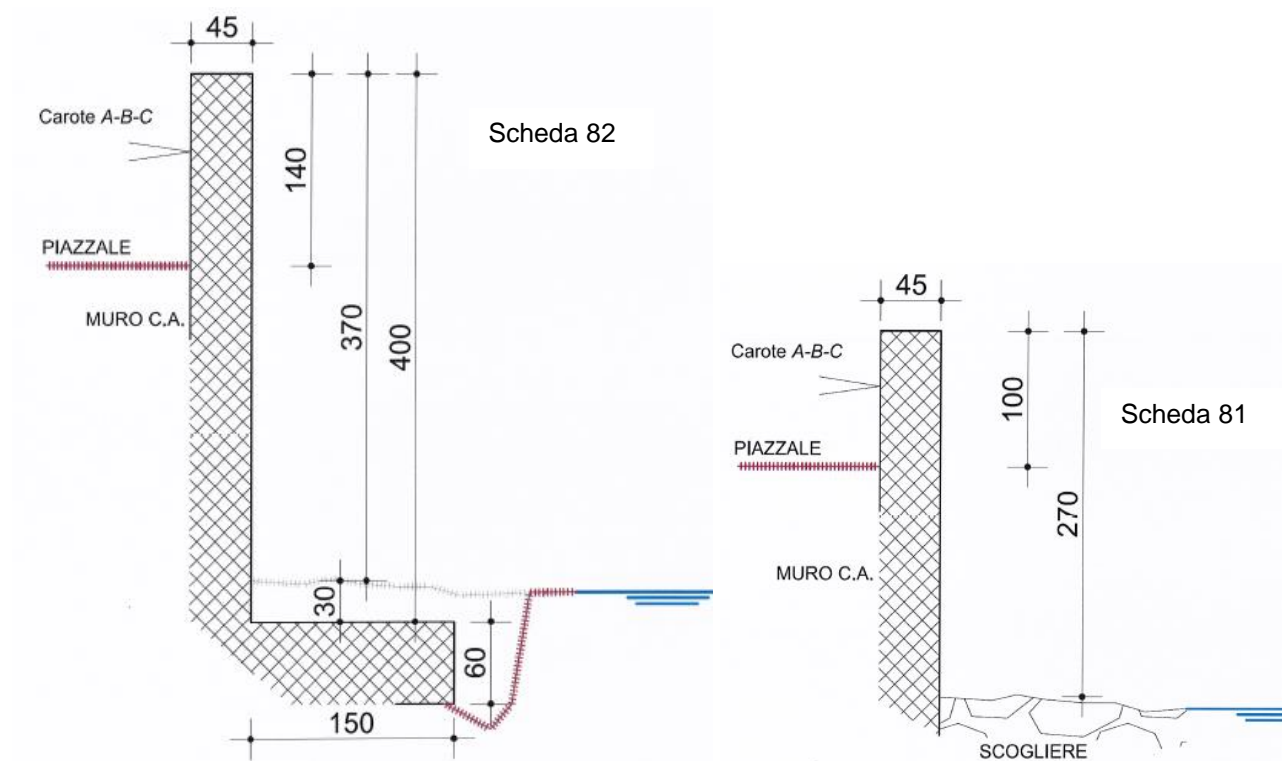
Sezione tipologica strutturale rilevata in sito
